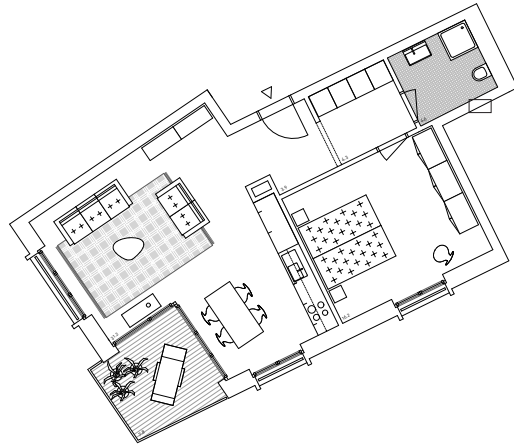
Rivo di Colla: Wohnung 2.5-Zimmer
